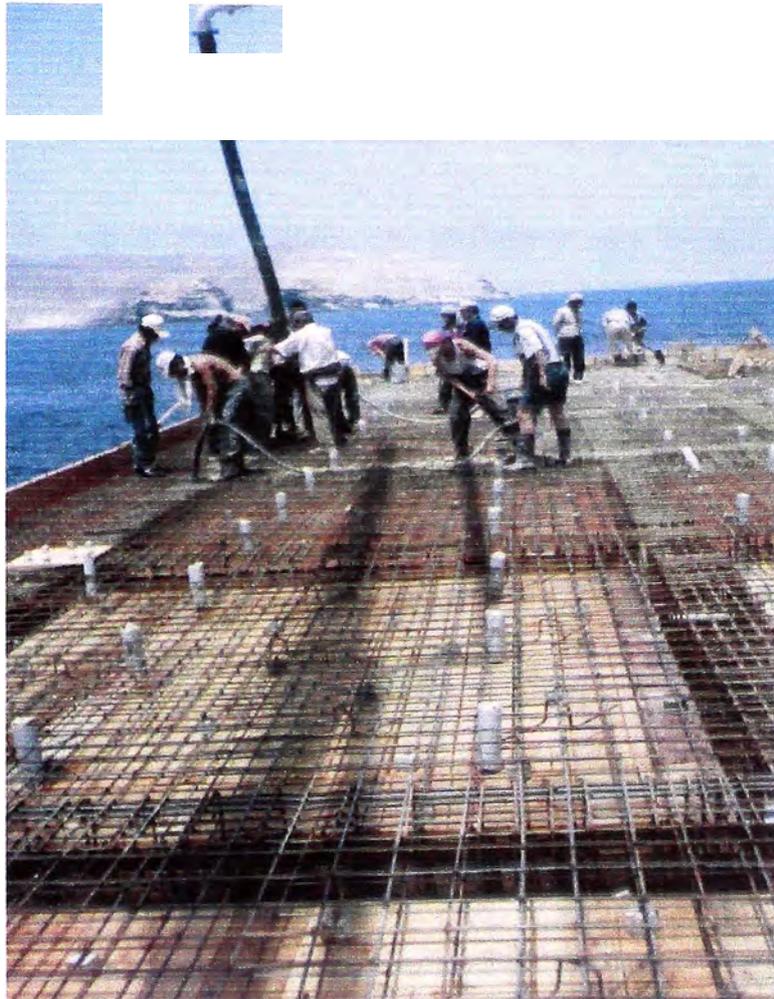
Vaciado de concreto en vigas longitudinales, transversales y losa en la zona del cabezo del muelle.
